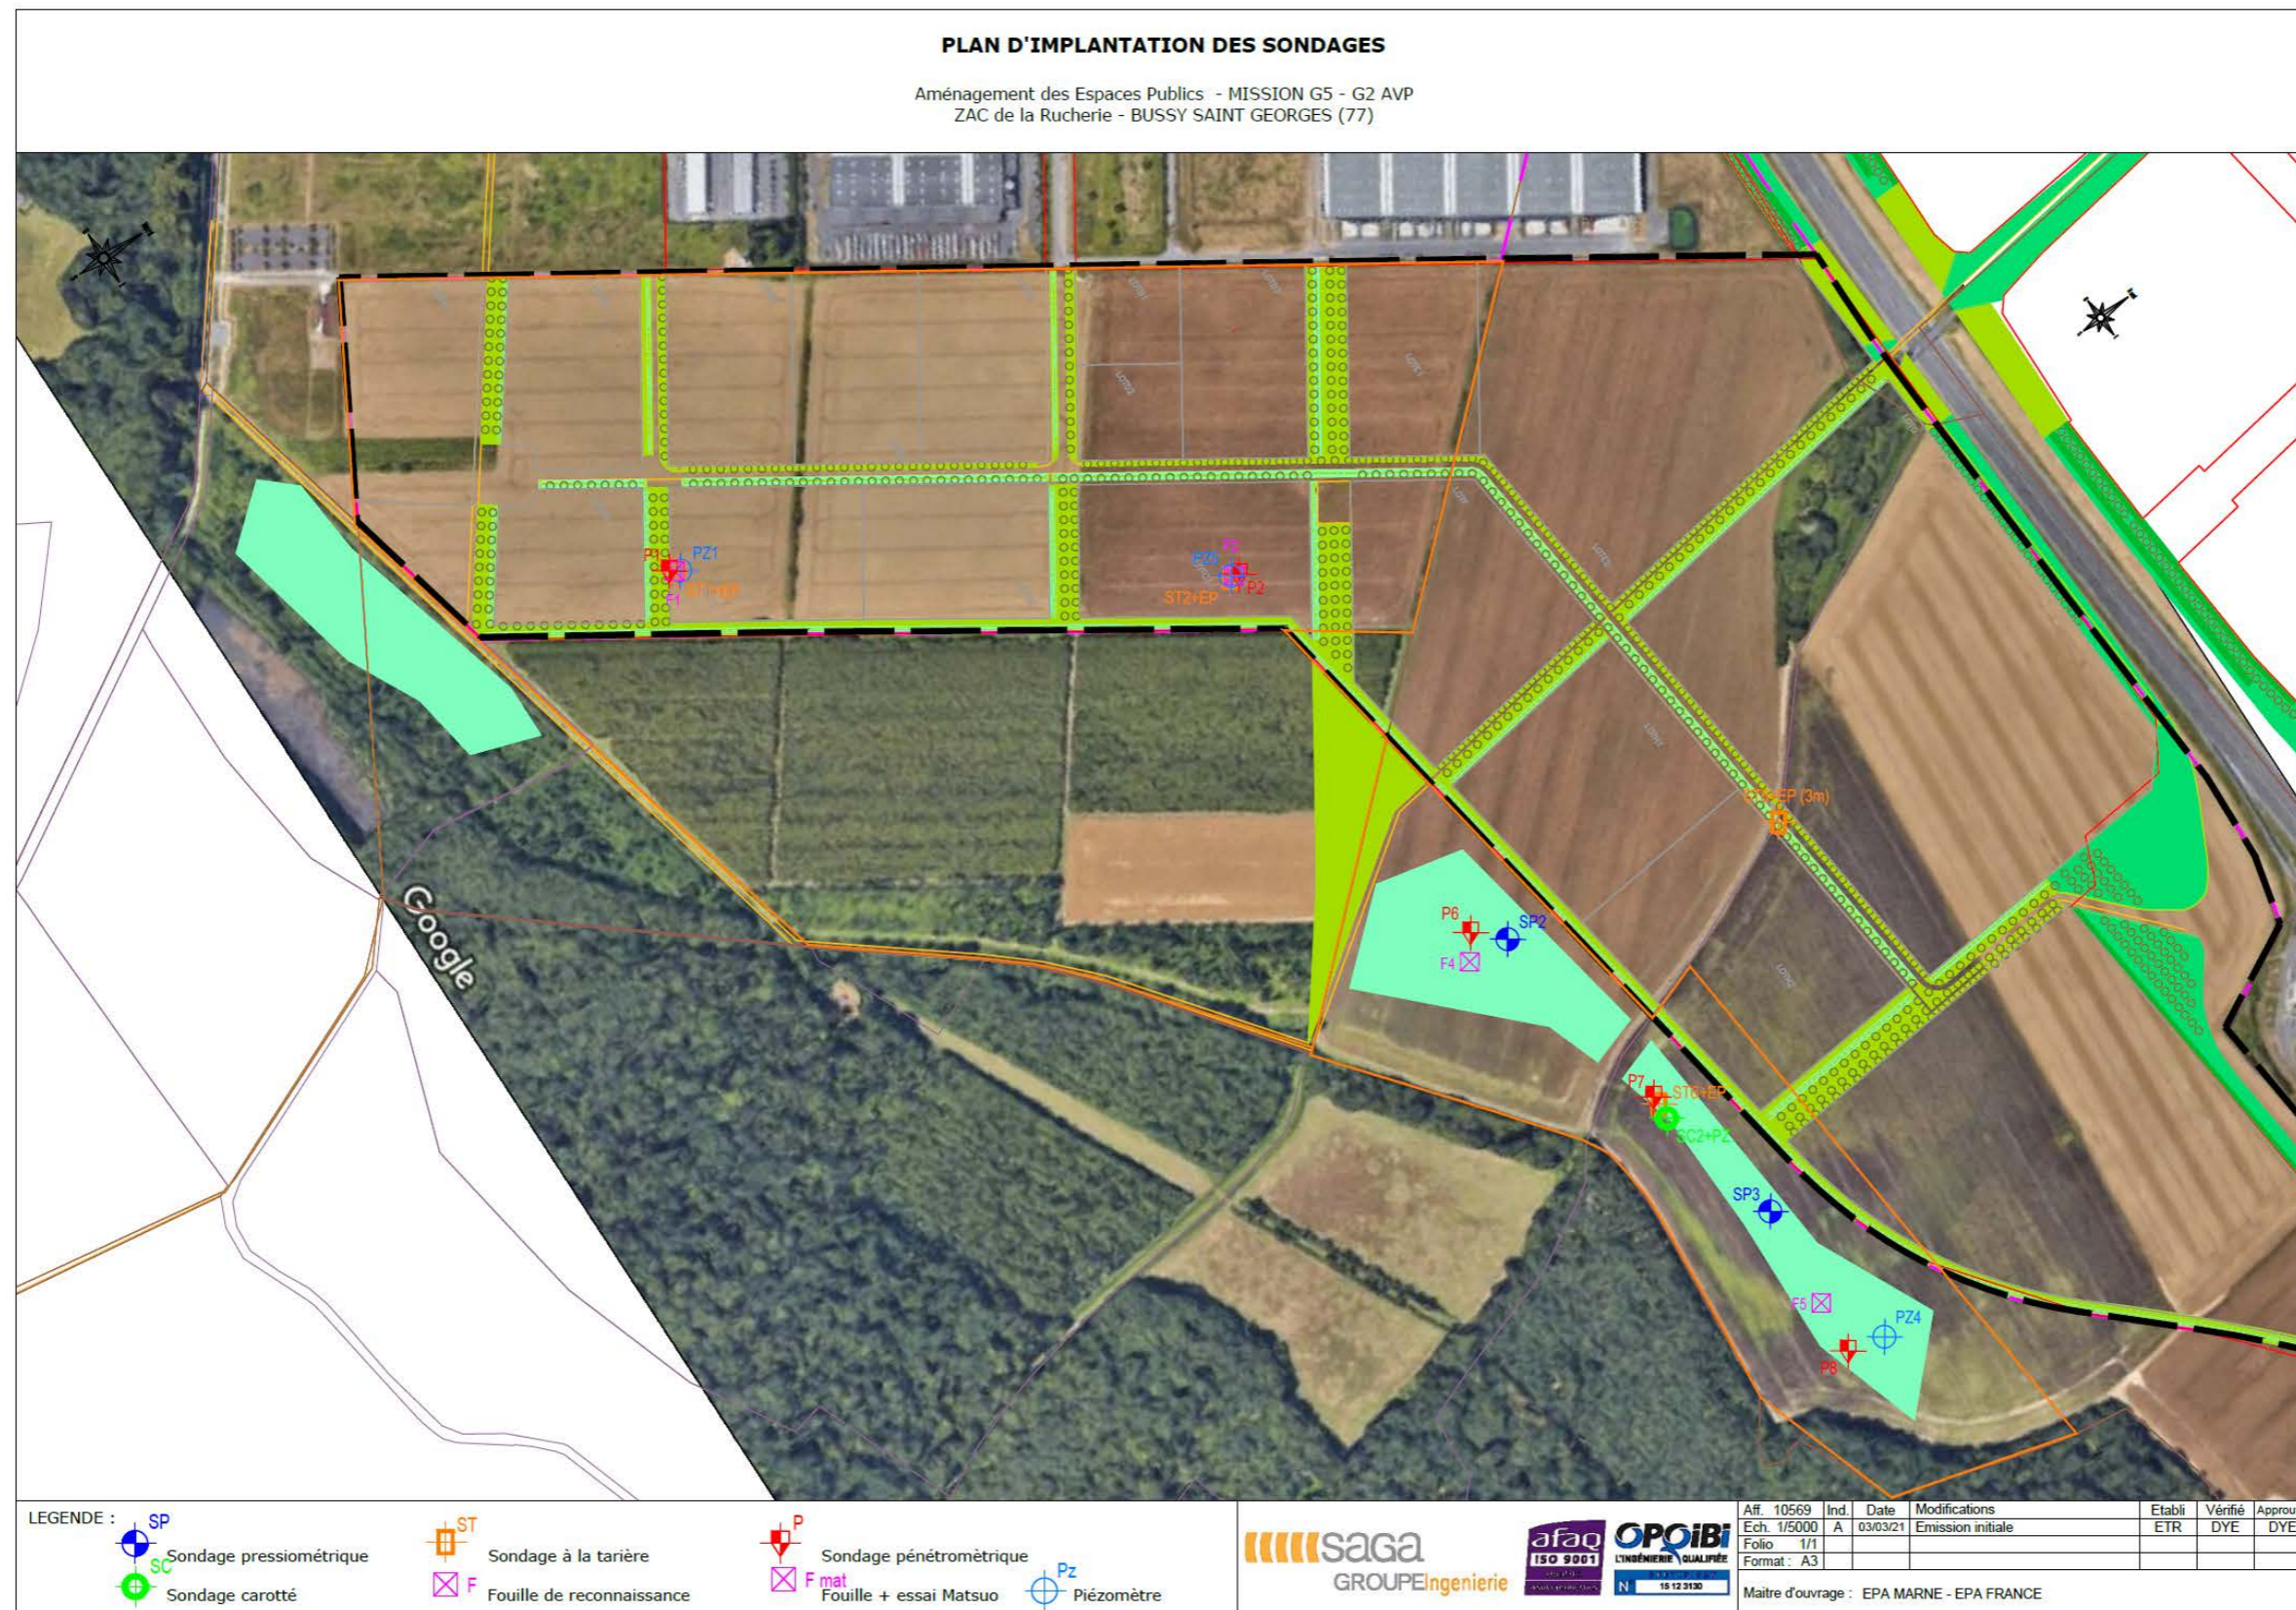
Plan d'implantation des sondages géotechniques (source : Géotechnique Vision 360 °)
